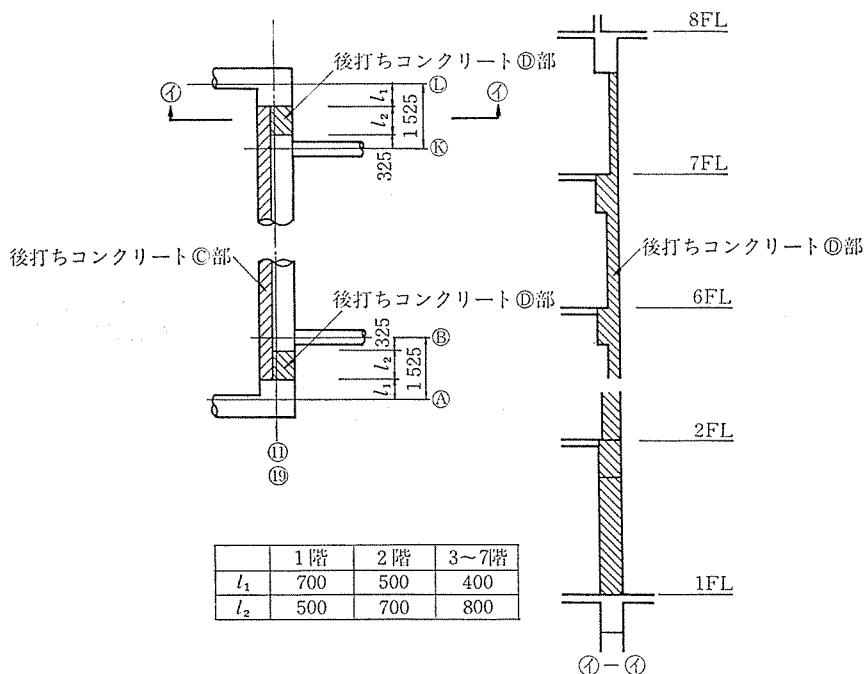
(c) 1~7 階後打ちコンクリート ②部詳細図
